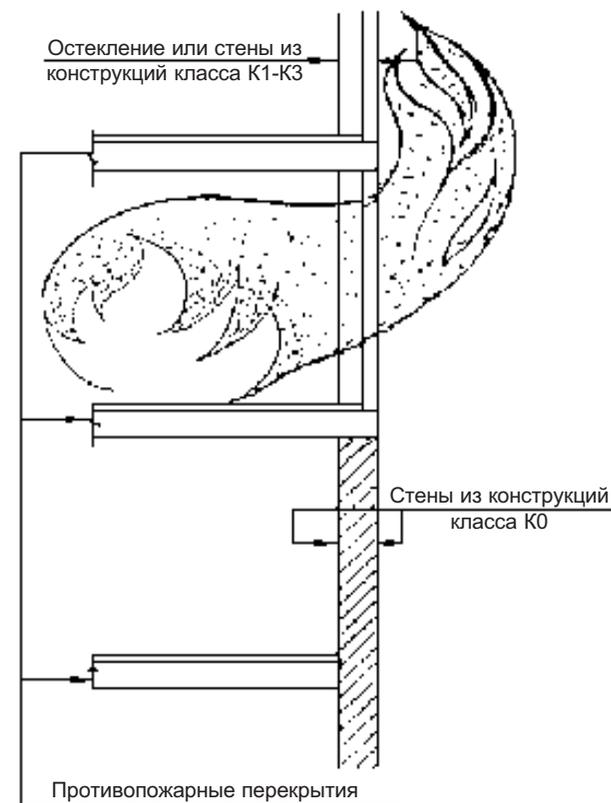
Примыкание противопожарного перекрытия к наружной стене
